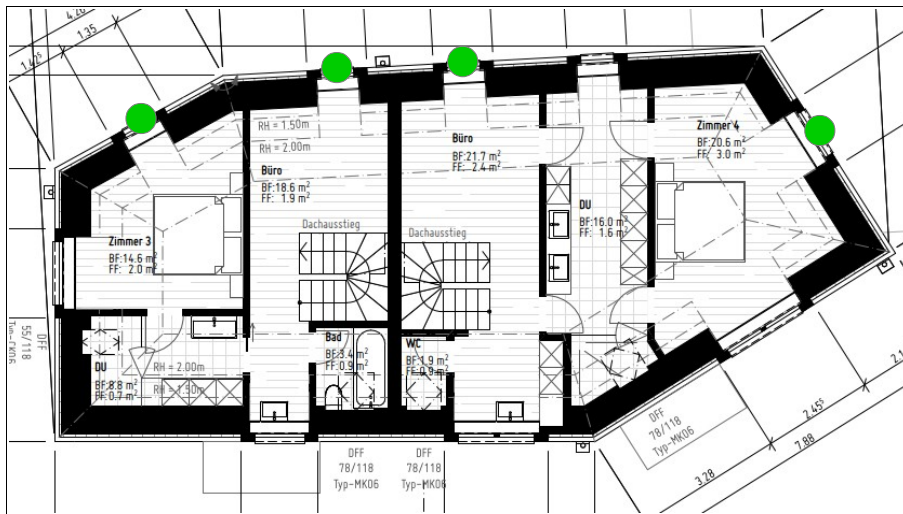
Grundriss DG, ohne Mst.; Quelle: Architekt
